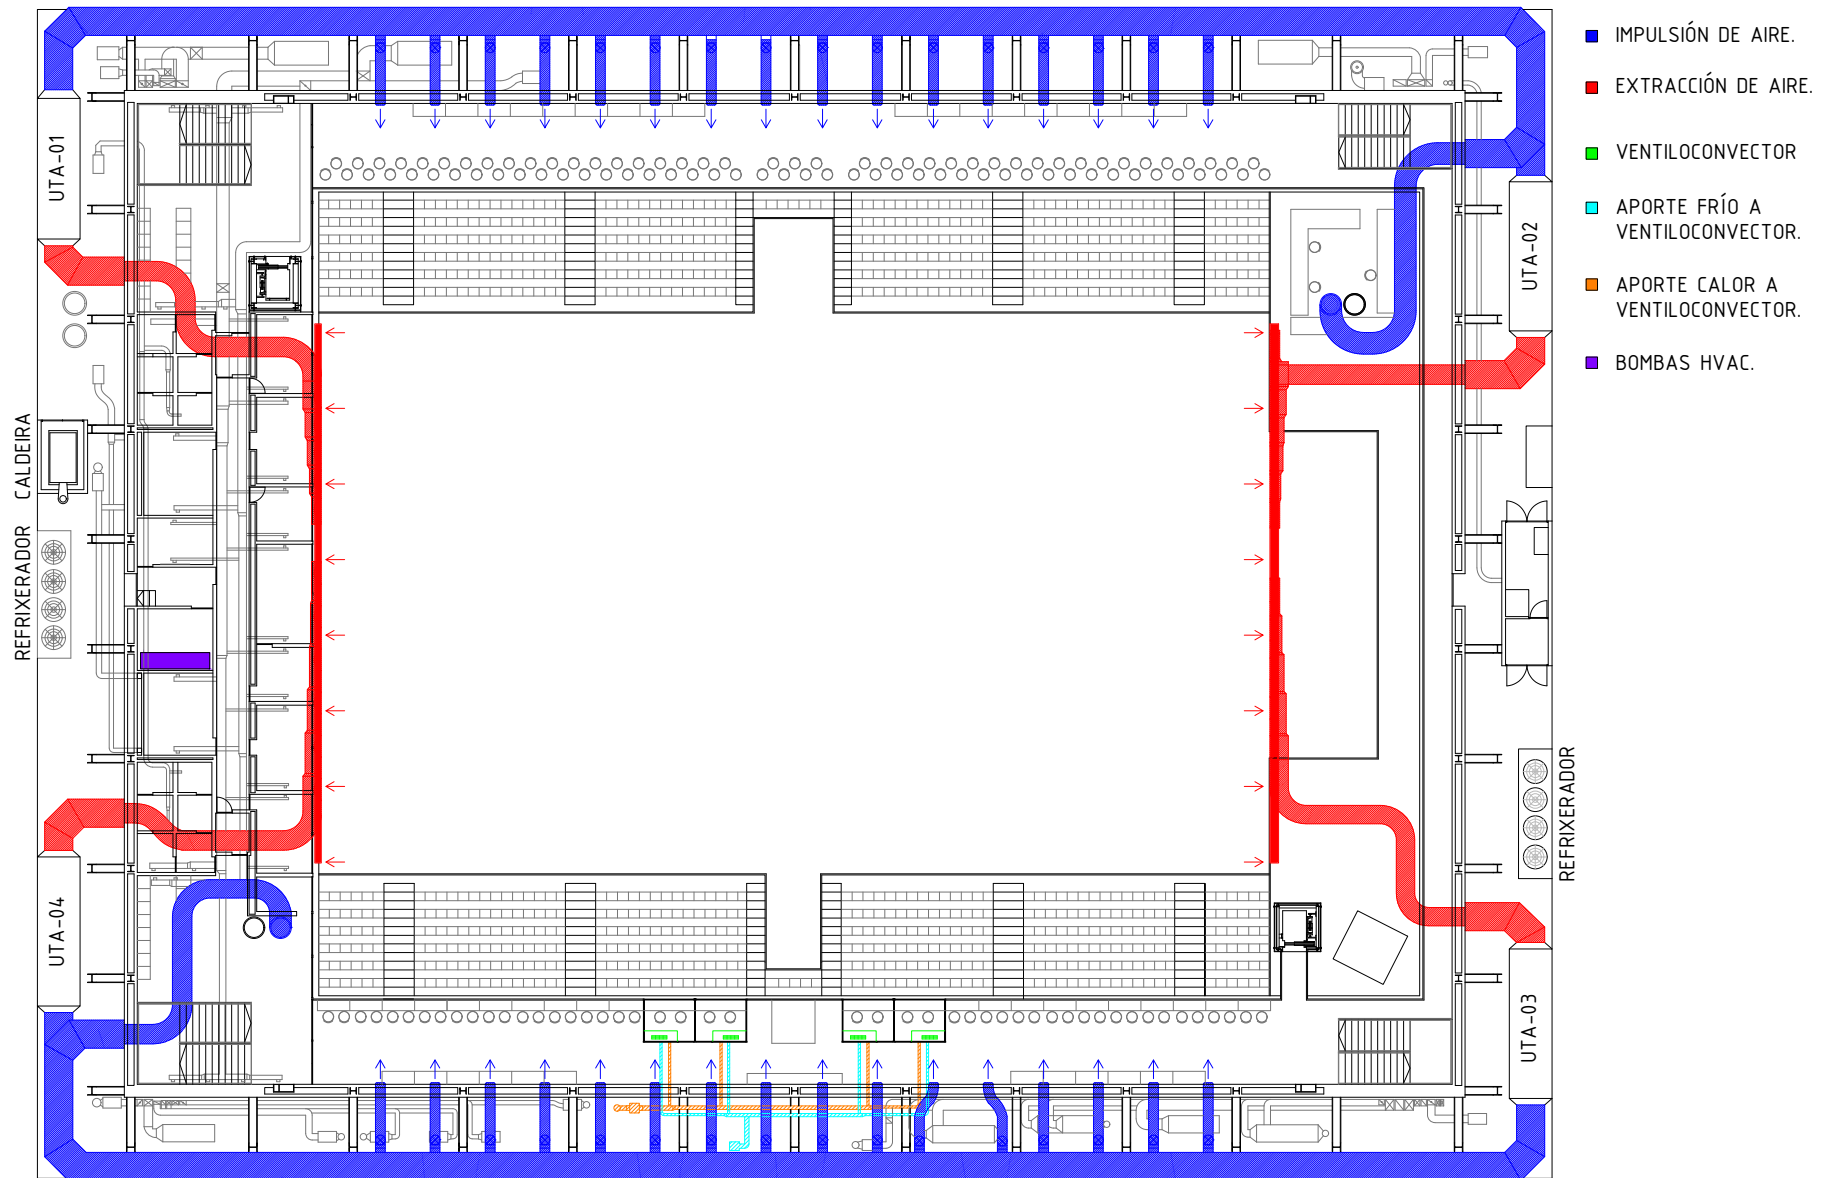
Planta primeira de HVAC do espazo principal. Escala 1/350.
